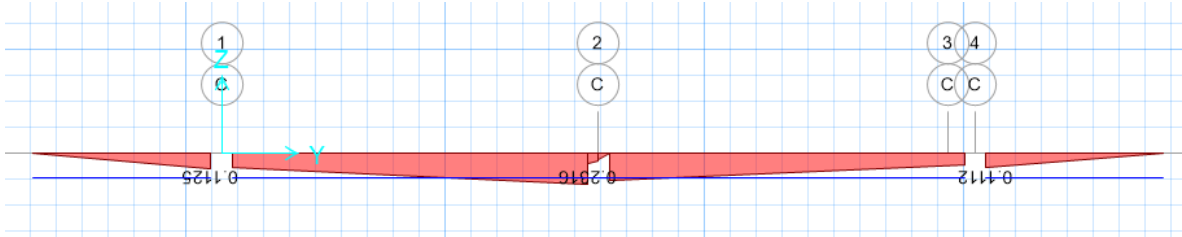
Área de refuerzo en dirección y por franja (losa de sistema de alimentación)
